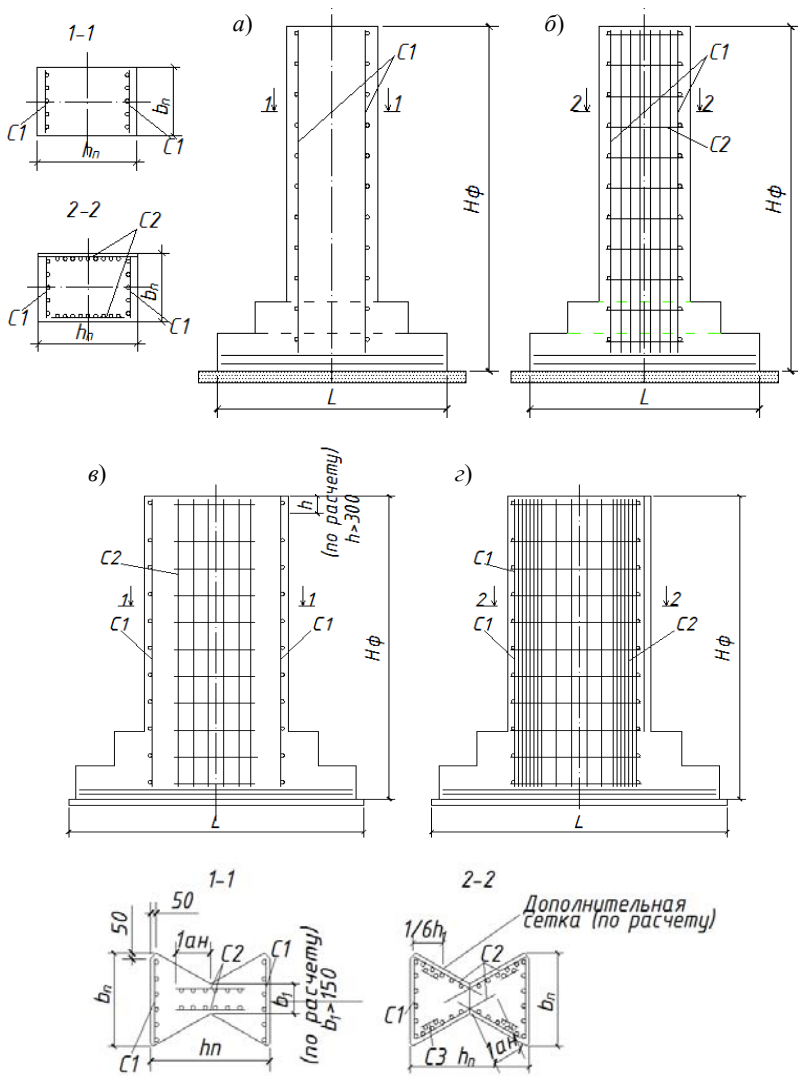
Армирование отдельных фундаментов с удлиненным подколонником:
